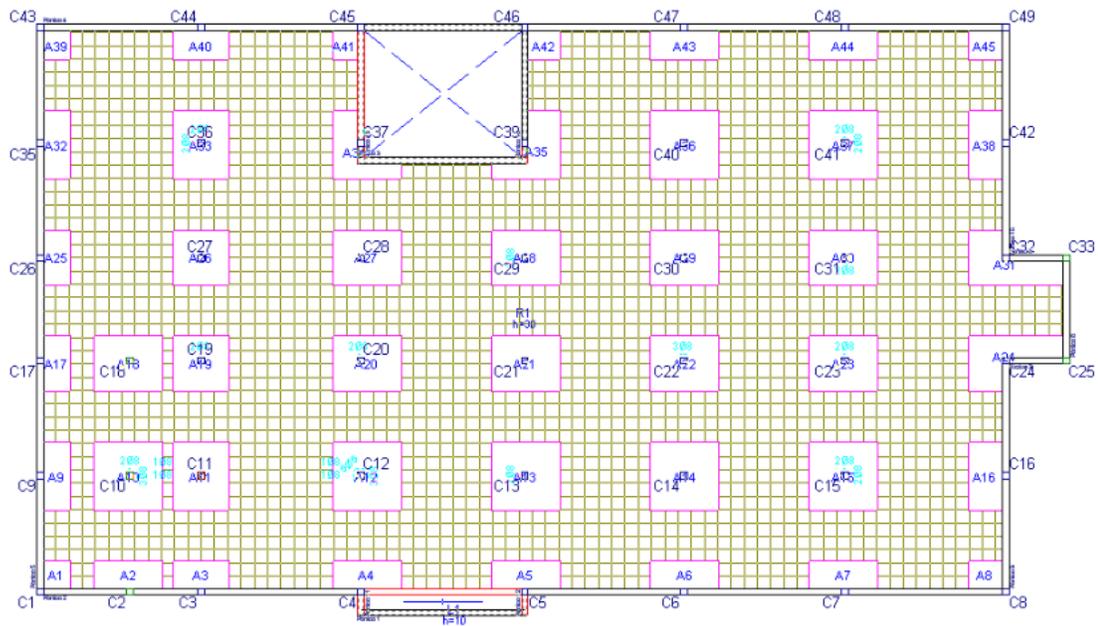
Vista en planta losa $h=30\text{cm}$ sin vigas de arriostre.⁶
